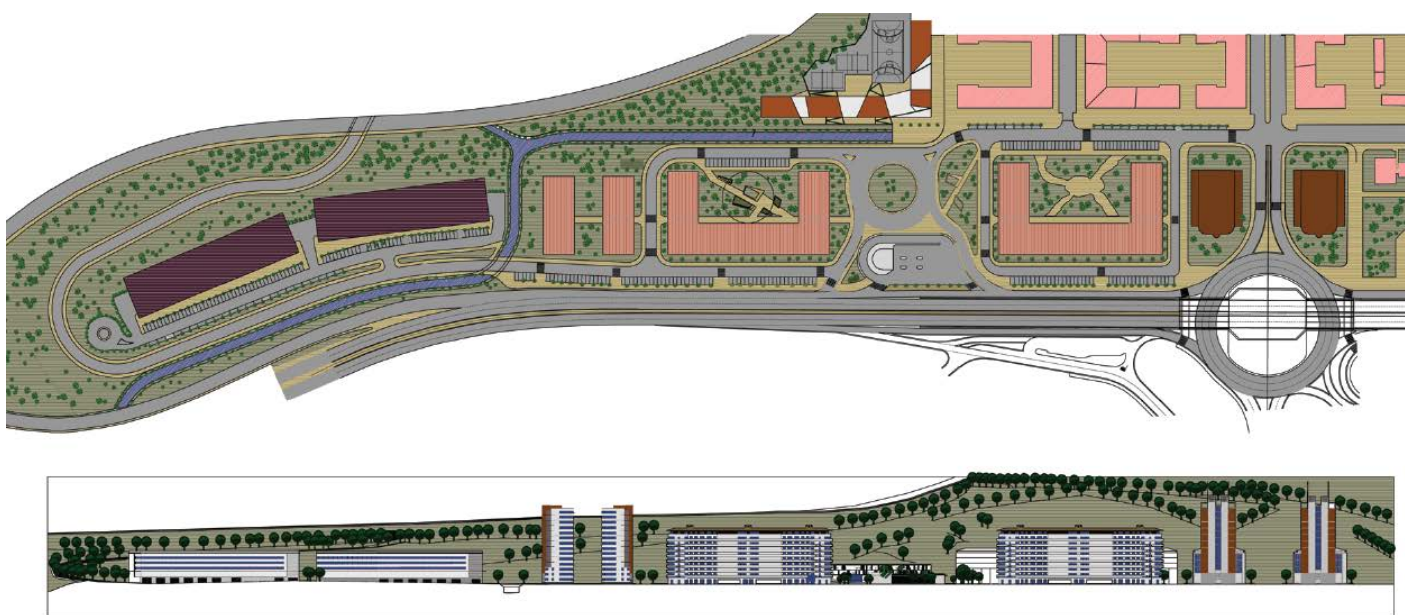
Planta y alzado general de la alternativa 1. Fuente: Modificación del PGOU.
